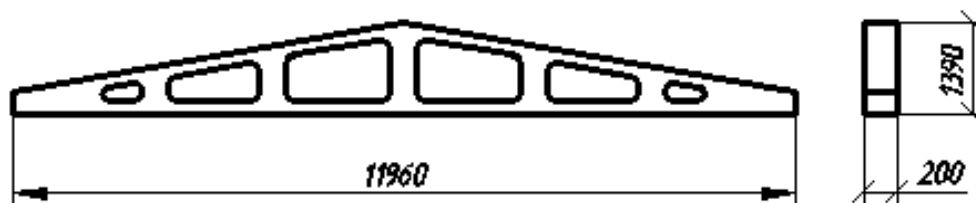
Железобетонная ферма серии 1.462-3
